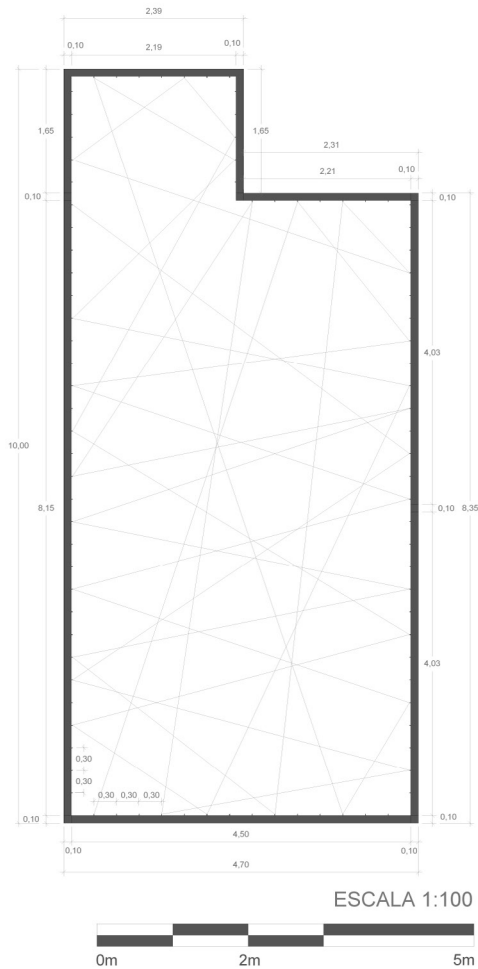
Localização e pormenorização construtiva da pérgula e do deck de madeira.
